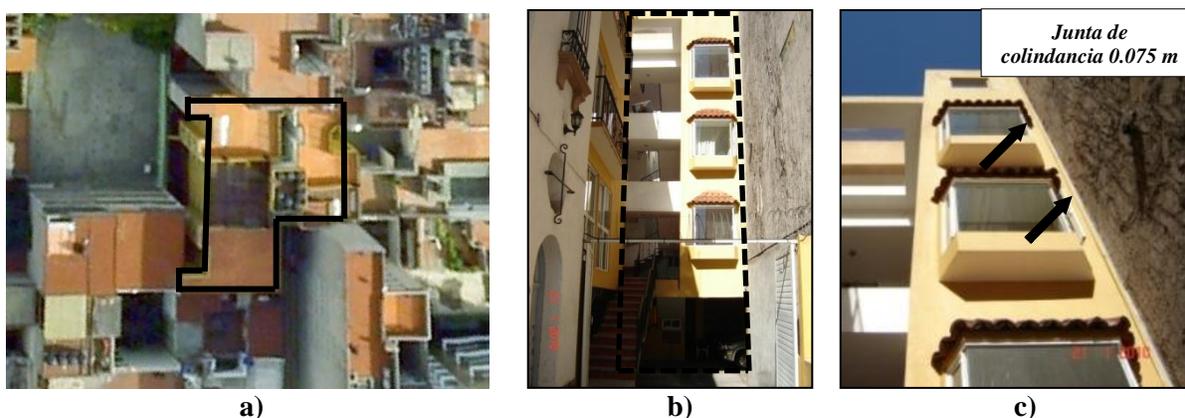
a) Configuración en planta, b) configuración en elevación, y c) Separación de edificios colindantes
